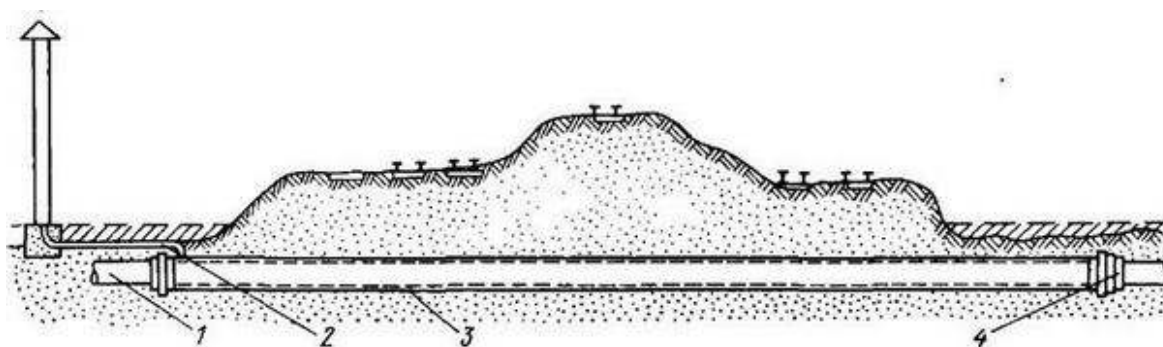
Схема пересечения газопроводами высокого и среднего давления железнодорожных путей: 1 – газопровод; 2 – отводная трубка с дефлектором; 3 – стальной футляр; 4 – сальник
